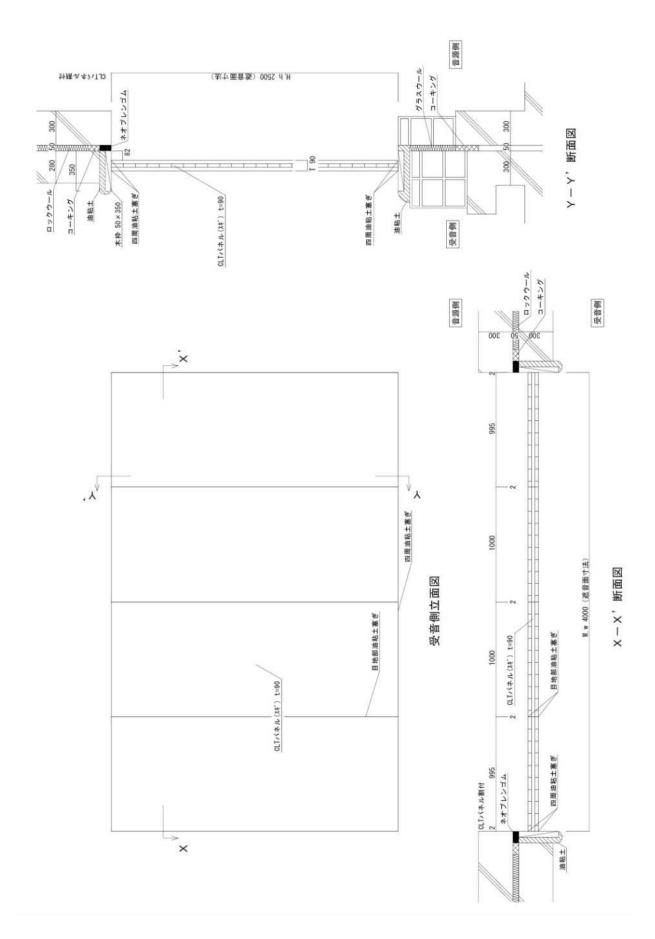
試験体 No.5の構造・寸法図 寸法単位:mm
